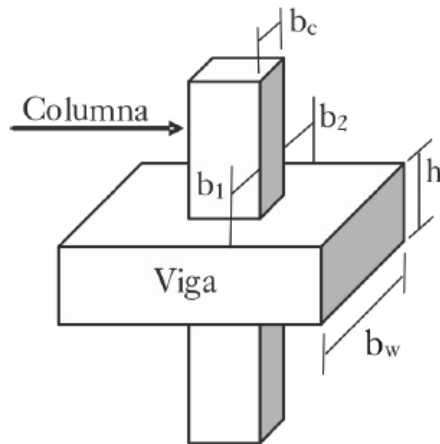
Geometría de Vigas para Pórticos Dúctiles de Concreto Reforzado.
